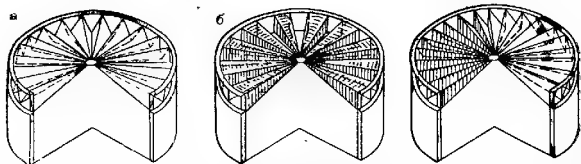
Складчатые радиальные покрытия с вантовыми фермами
